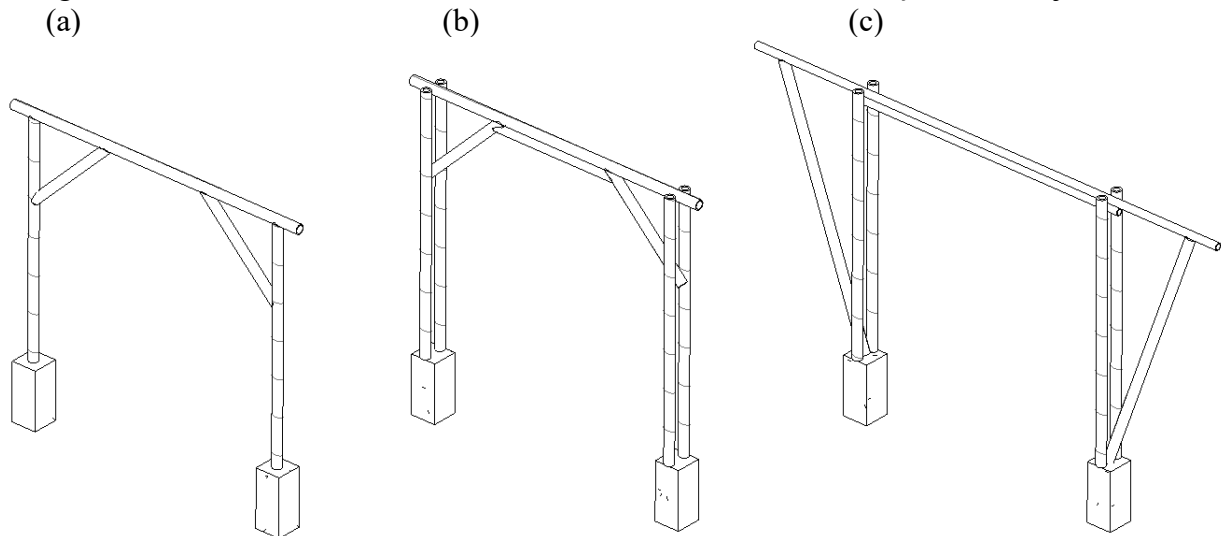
Pórticos simples variando em função do arranjo estrutural.
